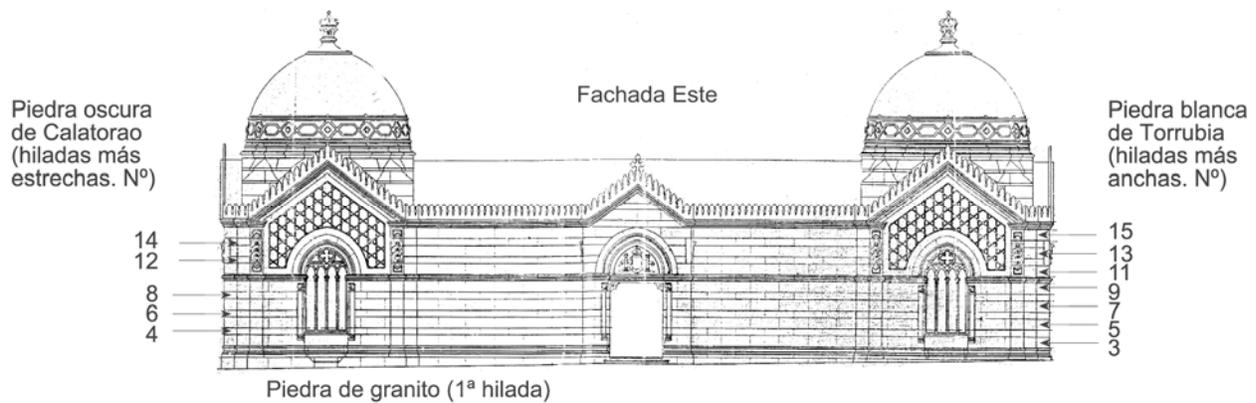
Alzado de la fachada principal del Panteón de Hombres Ilustres.
